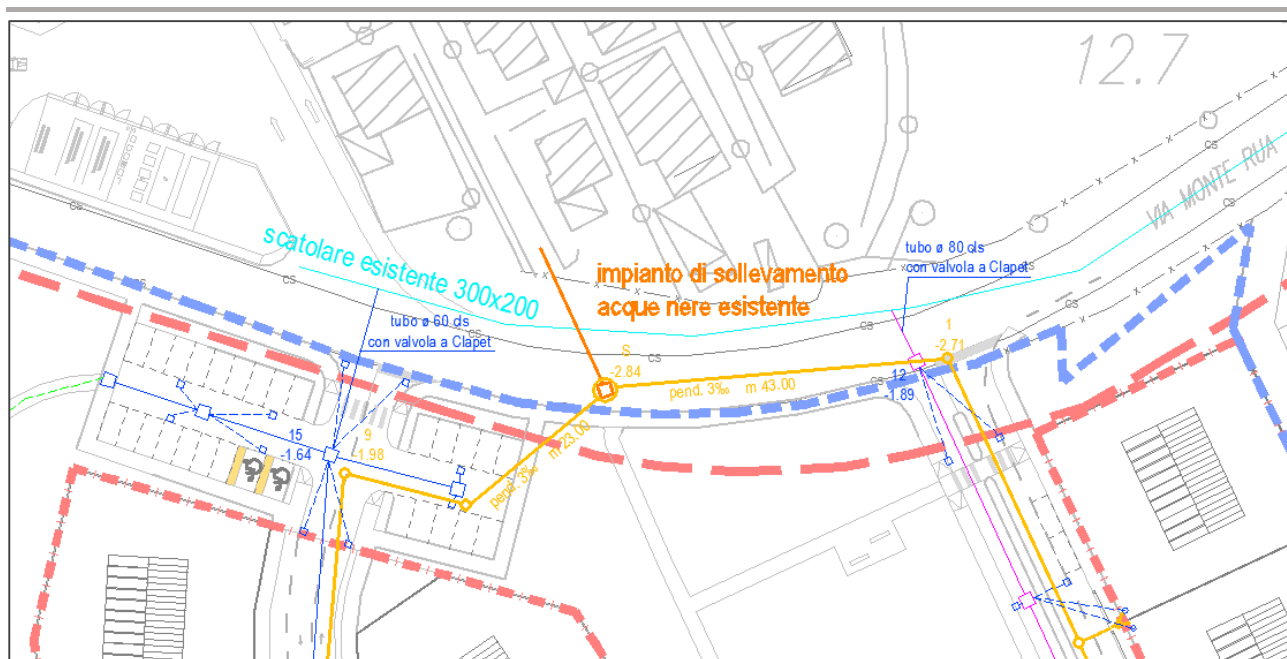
Estratto dalla tavola 8 di progetto del PdL - Schema reti acque bianche – nere
